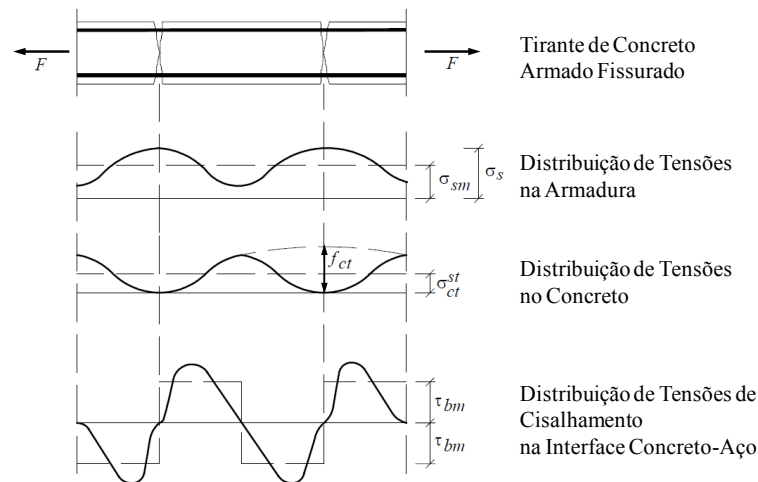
Distribuição de Tensões na Armadura, no Concreto e na Interface Armadura-Concreto em uma Peça de Concreto Armado sob Tração
